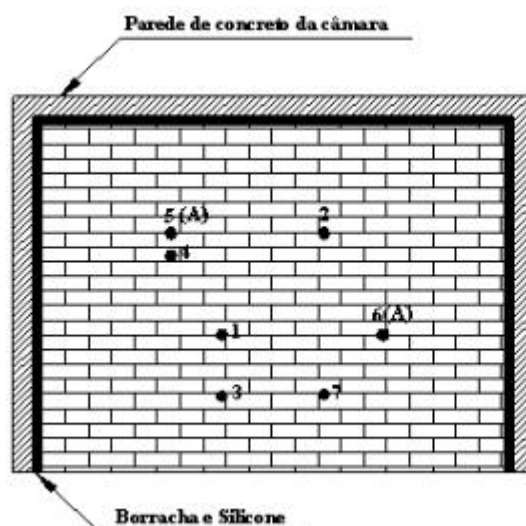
Pontos de excitação e colocação do acelerômetro na parede construída.
